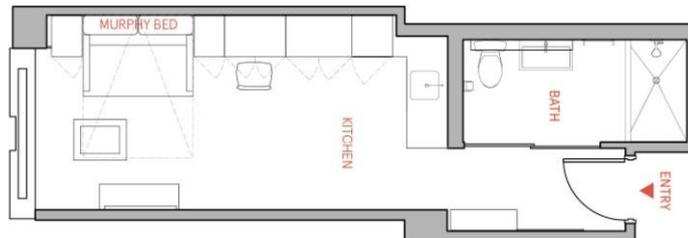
Departamentos tipo triple y cuádruple, Clark Street - Washington DC
